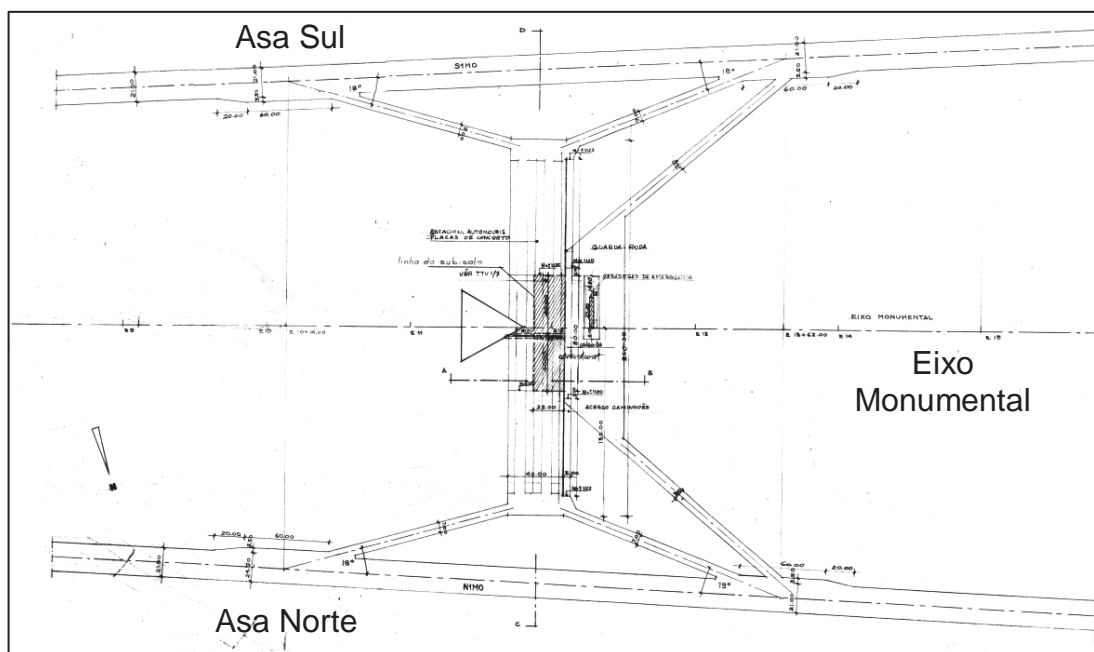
Planta de situação do projeto da Torre de TV (Fonte: ArPDF)
